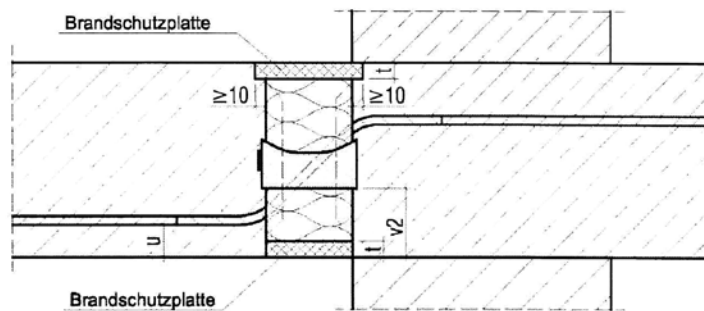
Schöck Isokorb Typ Q (Ausführungsvariante A) gem. Abschnitt 2.1.3, Var. a)
